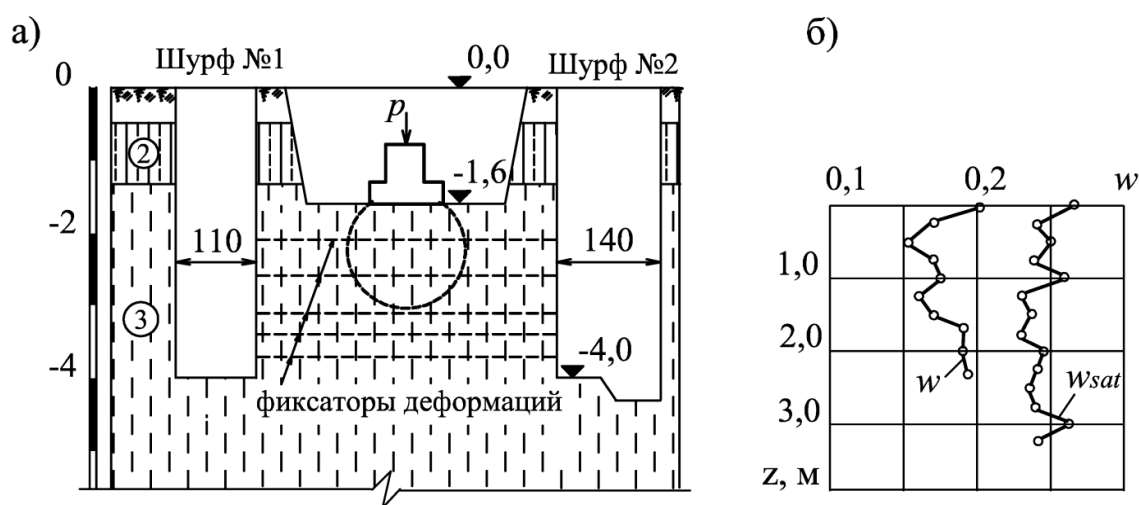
Схема испытаний грунта опытным фундаментом №1: а) геологическое строение участка; б) влажность грунта
